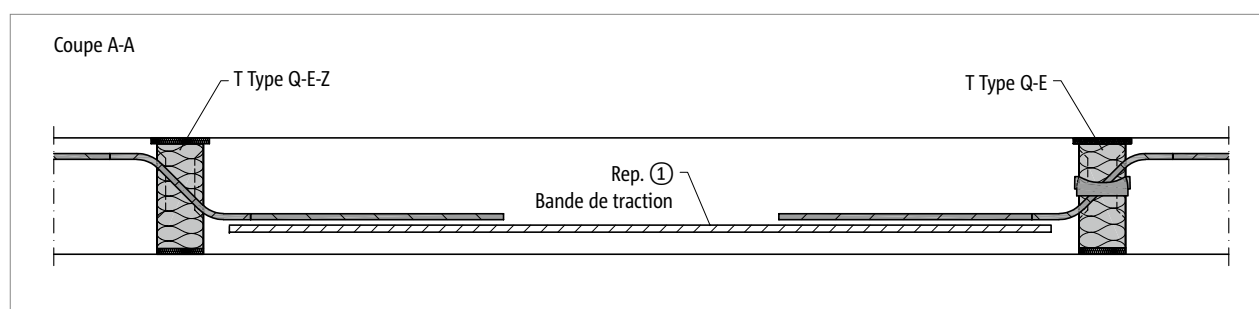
Schöck Isokorb® T Type Q-E, Q-E-Z : Coupe A-A ; application d'une dalle de béton à axe unique
